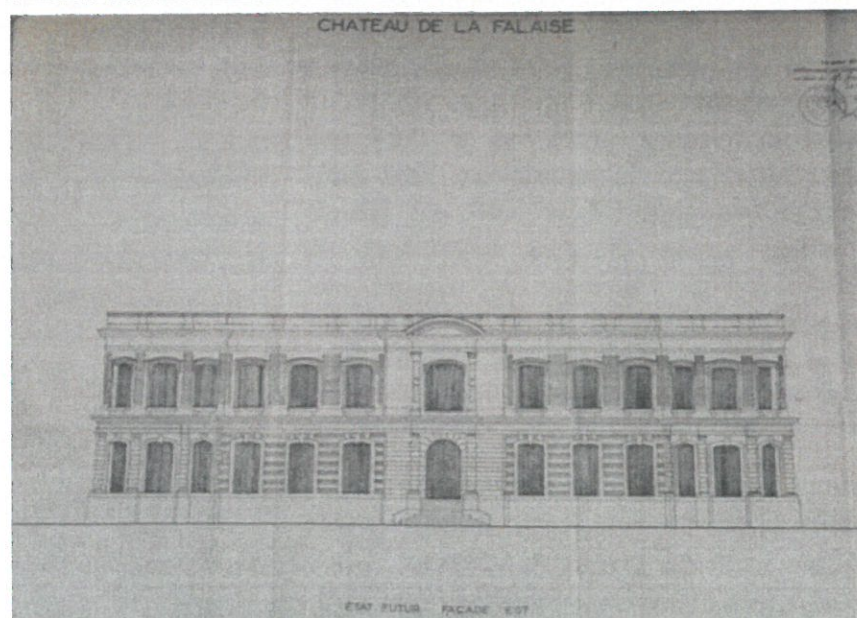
RABAUD, Olivier architecte, Elévation de la façade est du château de La Falaise, état futur, 1961, AMP
